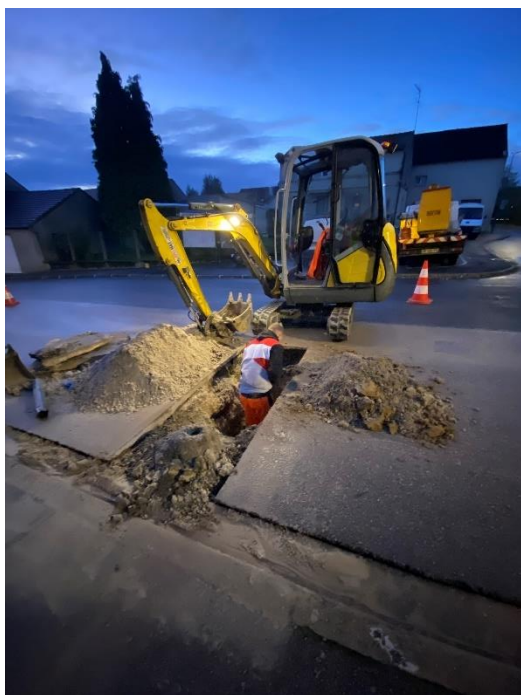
Fuite sur branchement – Rue Henri Thébault à Laigneville (novembre 2022)
